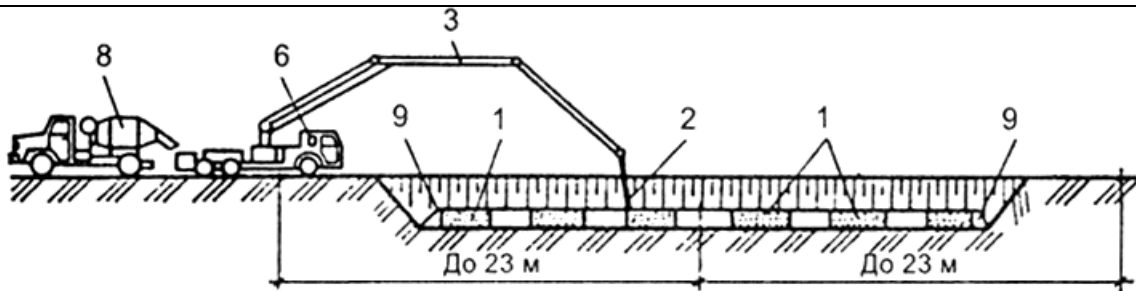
Бетонирование фундаментной плиты автобетононасосом
